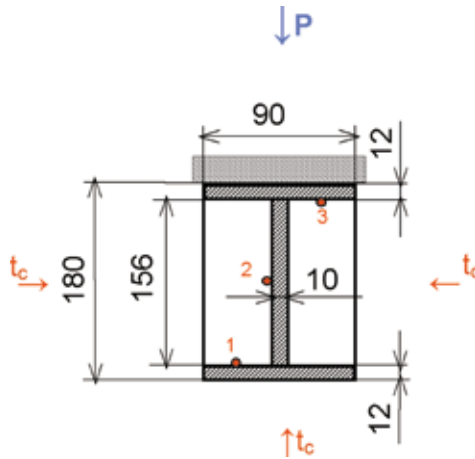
Опытный образец (поперечное сечение) стальной балки для испытаний на огнестойкость под нагрузкой
